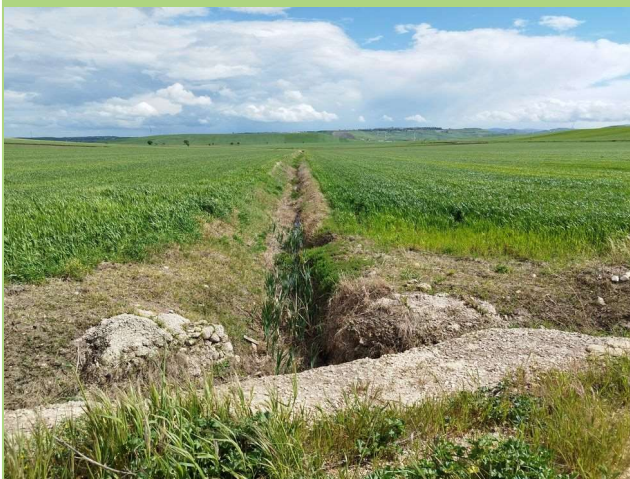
Sistema di irreggimentazione delle acque che attraversa il tracciato del cavidotto. Visuale est.
